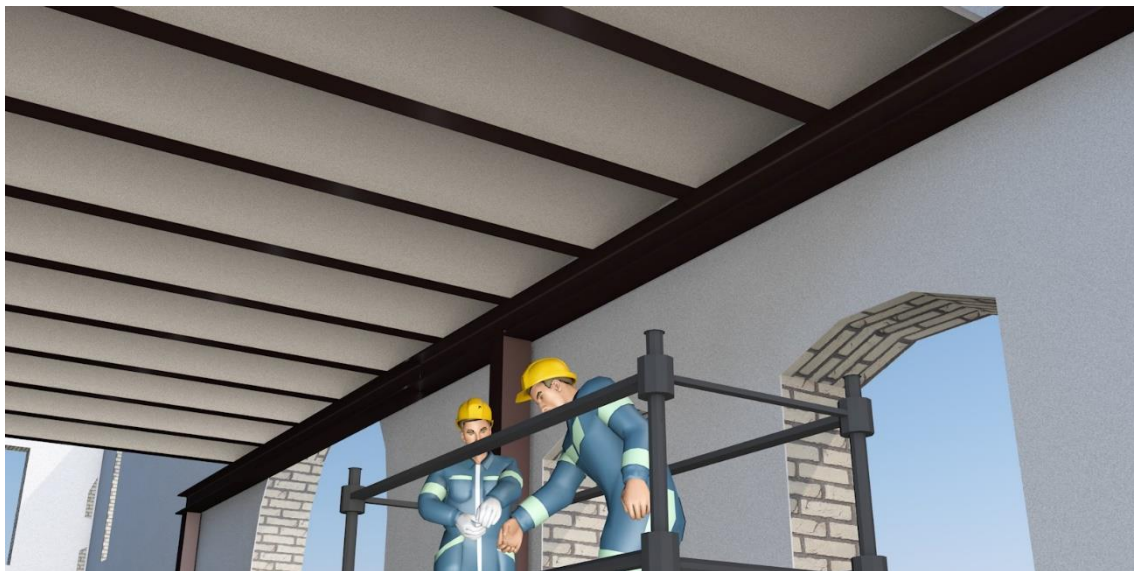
Colocación de los pilares metálicos. (Fuente: Elaboración propia)
